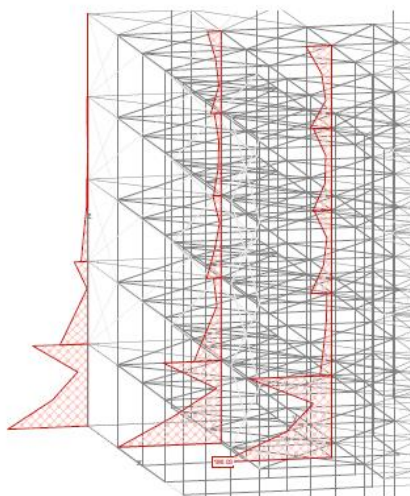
Distribución de momentos flectores en pilares en un edificio con planta diáfana.
